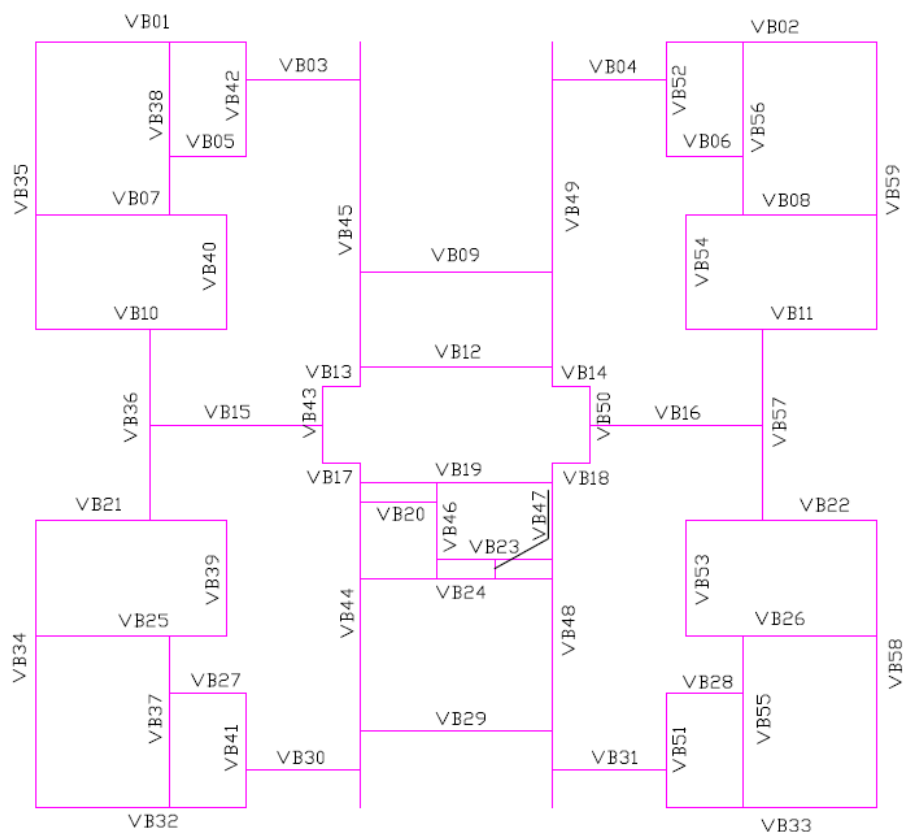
Vigas baldrame do edifício quadrado com fundação profunda.
